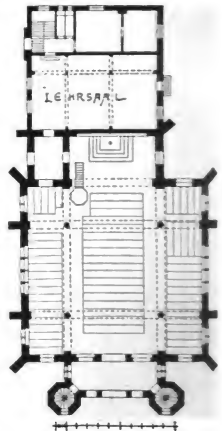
Grundriss der Friedenskirche. J. Rippe. 1868.
